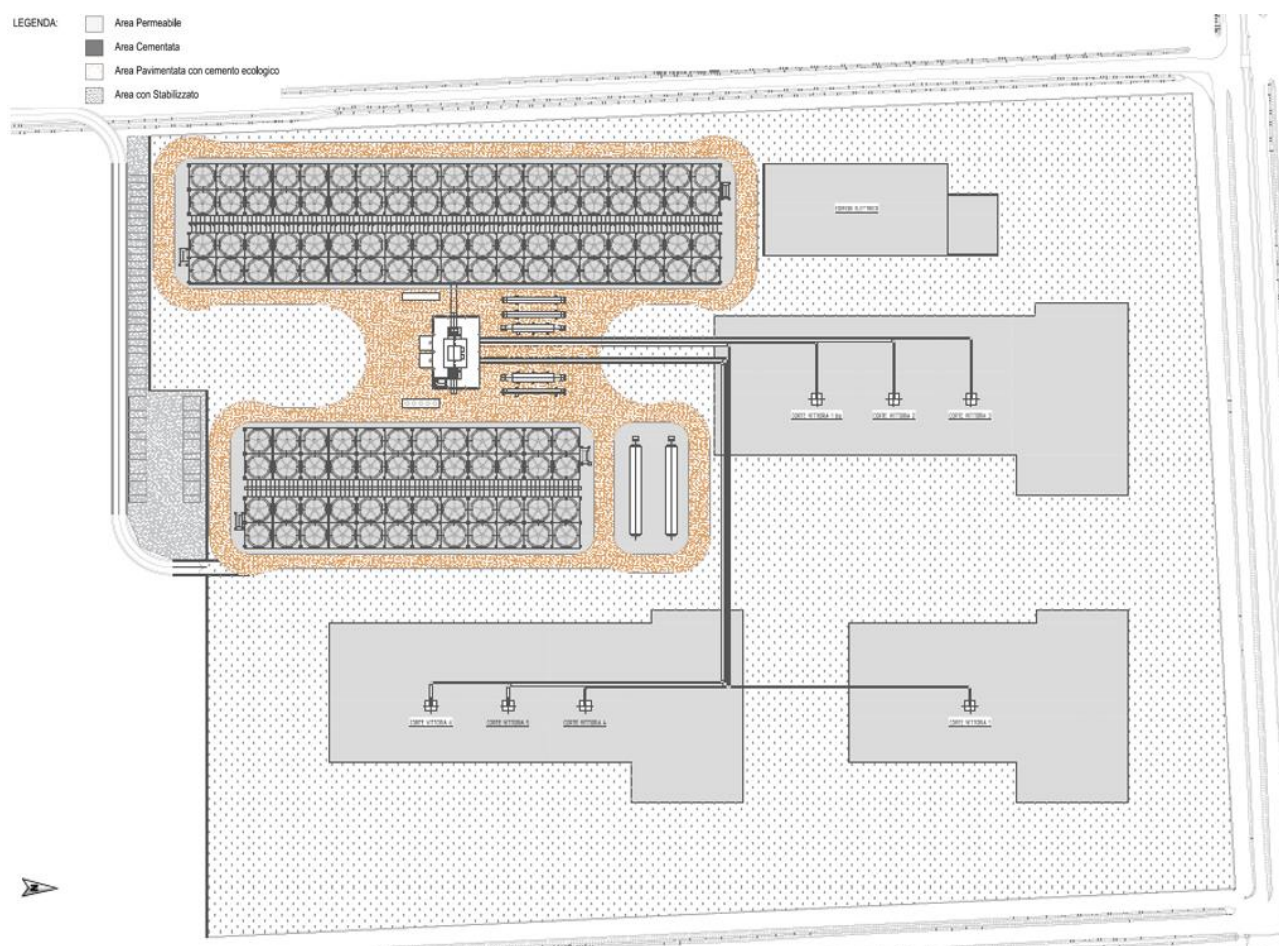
Layout generale impianto geotermico (estratto fuori scala da tav. Impianto geotermico layout generale di impianto)
